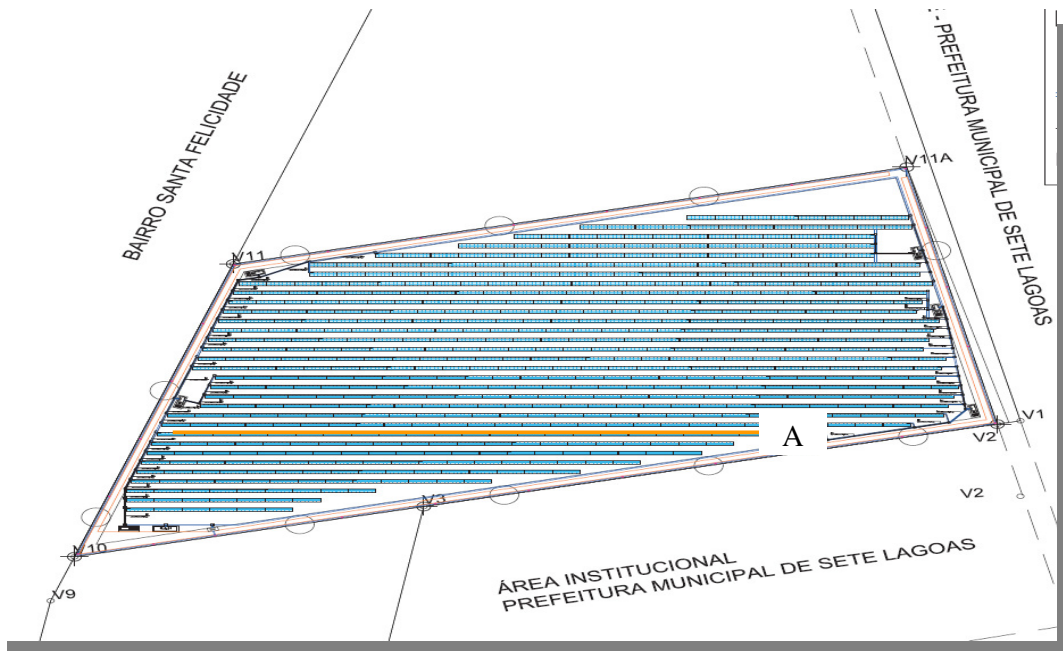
Planta Fotovoltaica 3MW - Sete lagoas.
